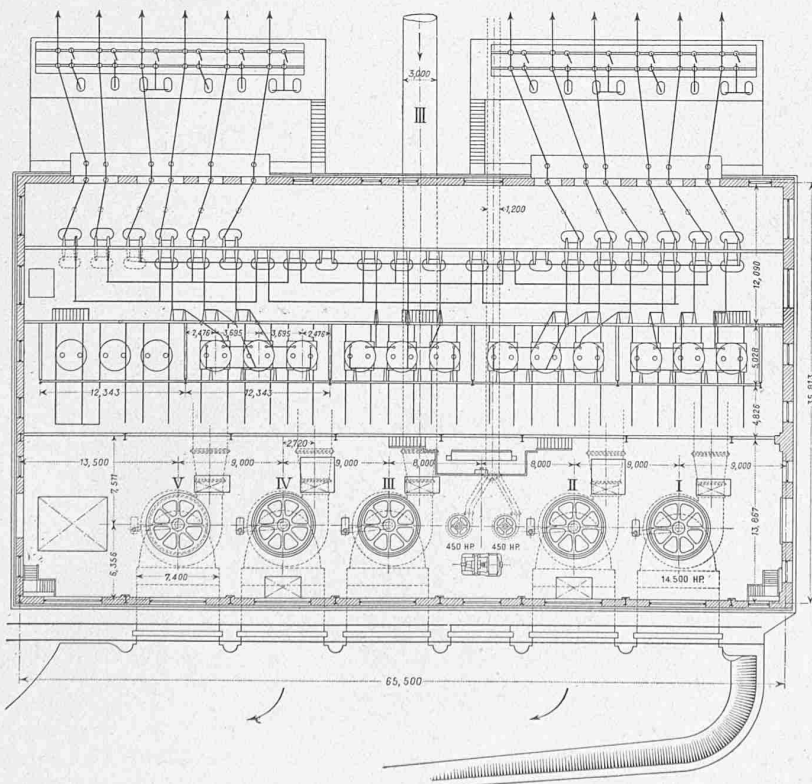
Grundriss des Maschinenhauses. — Masstab 1 : 600 (vergl. Abb. 74).
